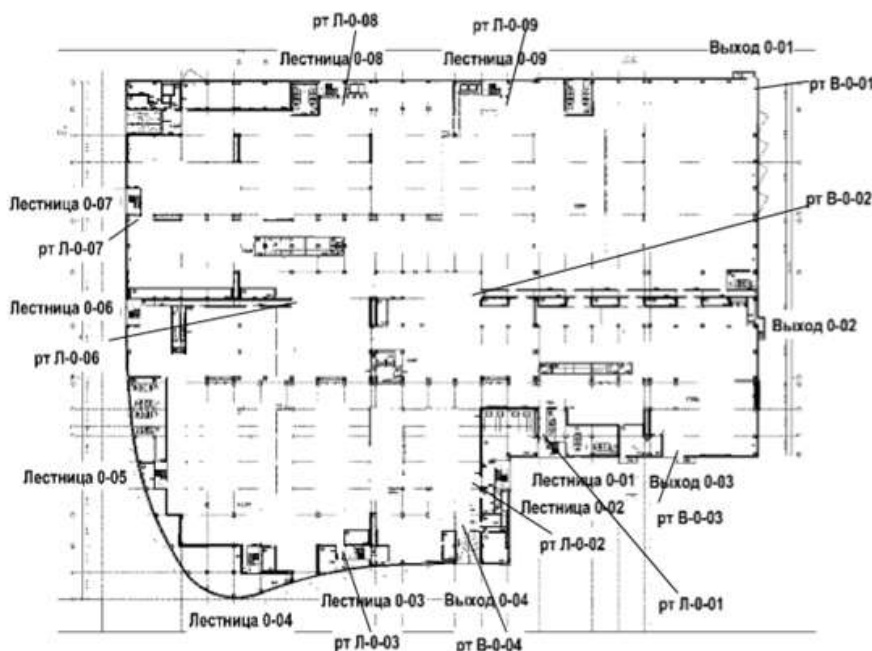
Расчетная схема эвакуации людей из подвального этажа при пожаре в подвальном этаже
